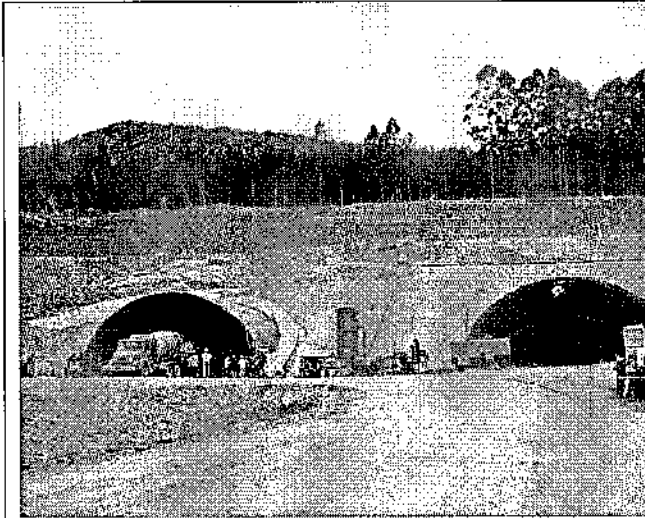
Início de construção do emboque norte, Lote 03/RS
